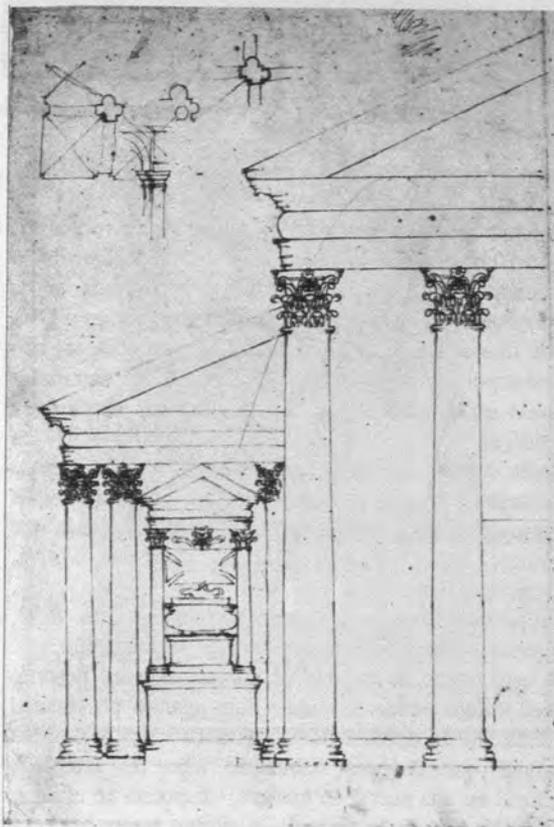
Supuesto proyecto de Palladio para la fachada de S. Giorgio.
